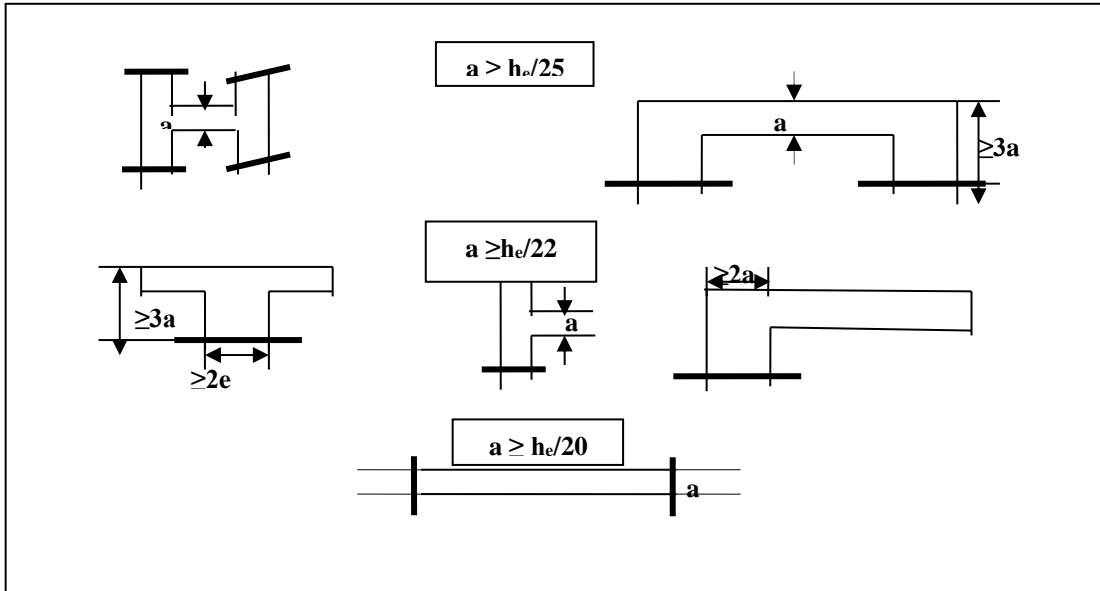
Coupes de voiles en plan pour différents cas.
